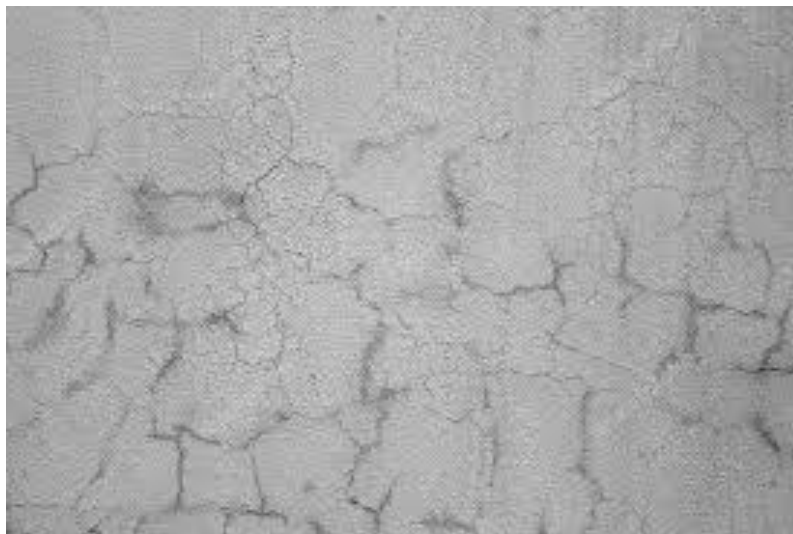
Típica Fisuración por retracción plástica.
